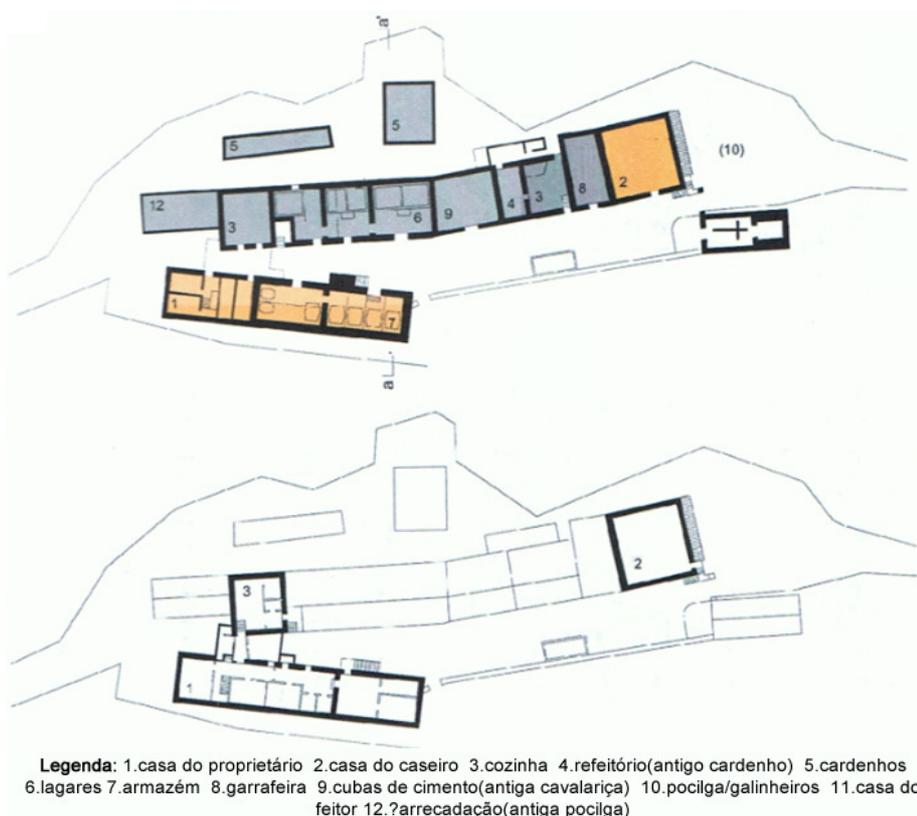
Planta da Quinta do Paço de Monsul (retirado de [4])
